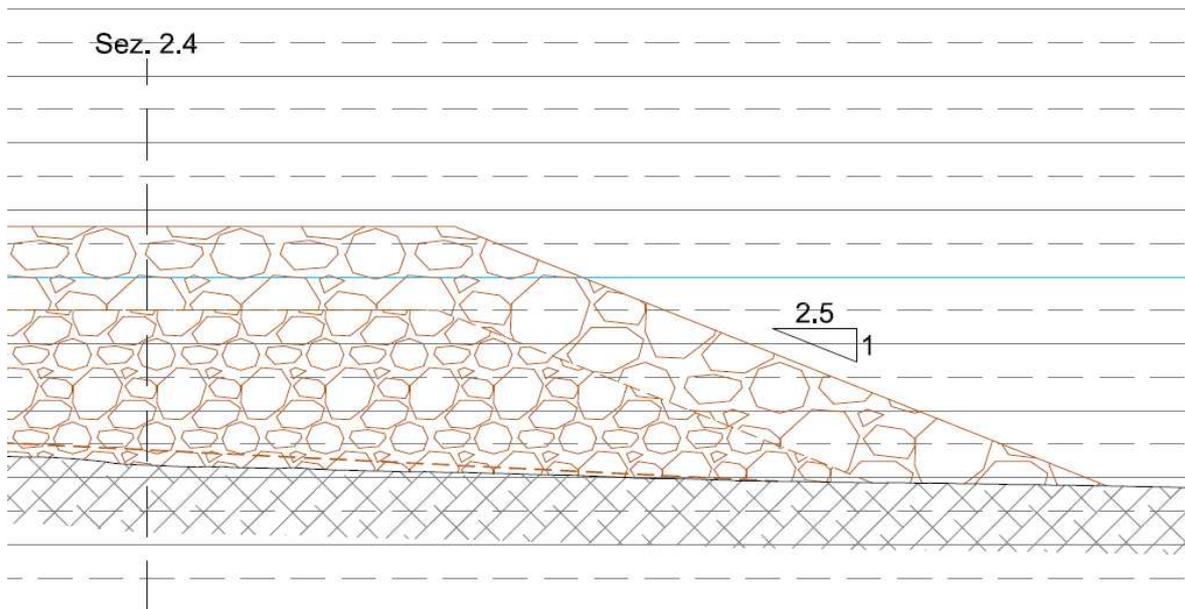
stralcio della sezione longitudinale del pennello P2 a progetto
